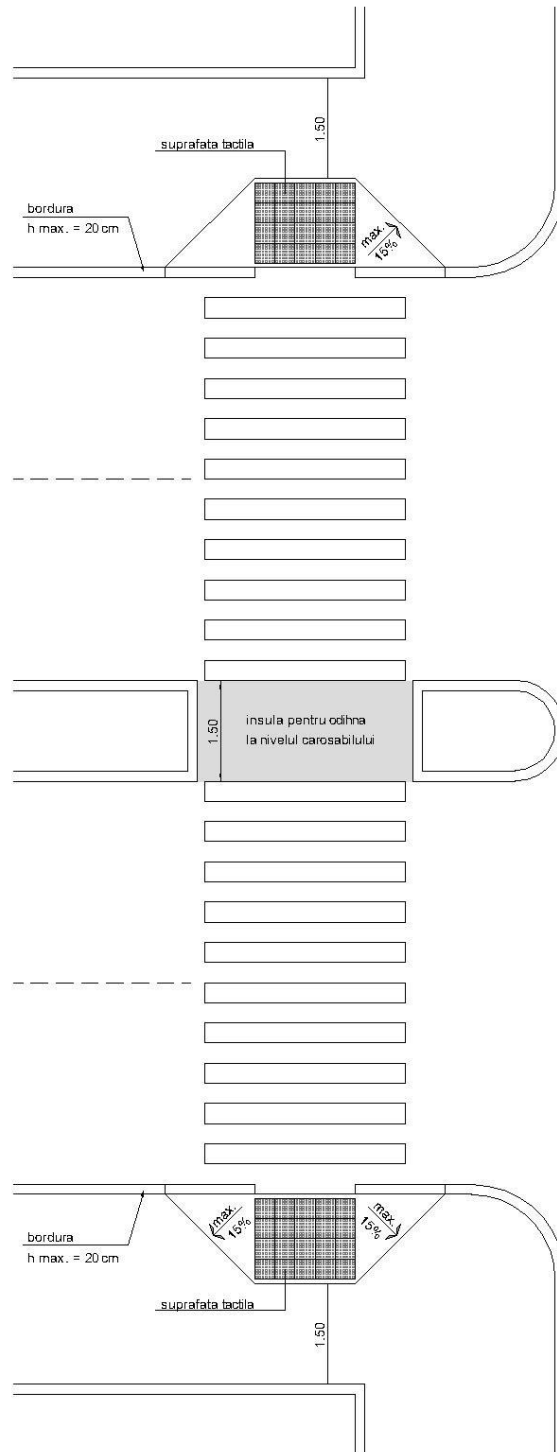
1. – Traversarea străzilor cu lățime > 4 benzi de circulație
